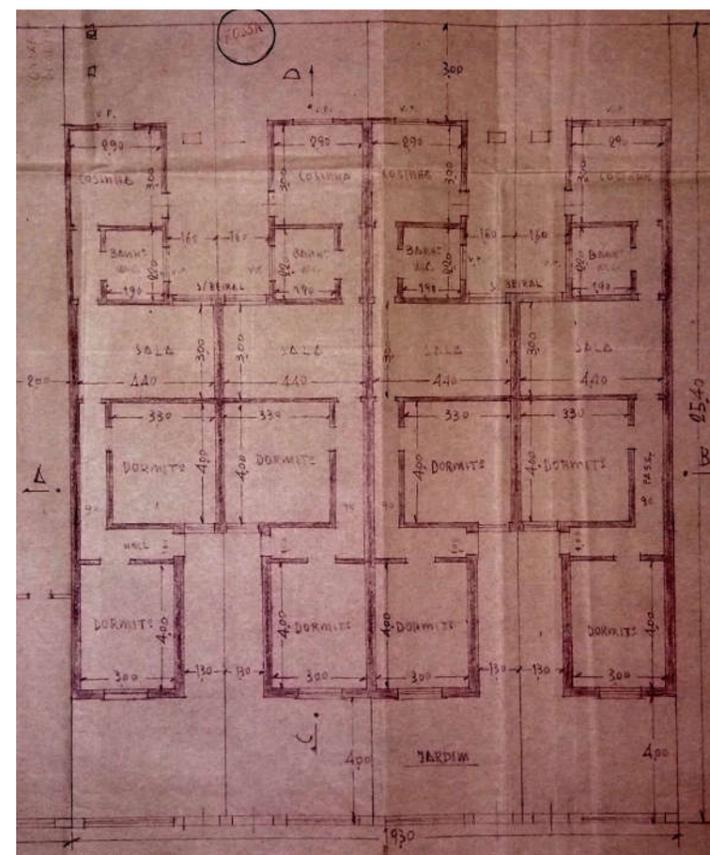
Foto do projeto, com o detalhe da planta. Fonte: (GUARULHOS, 1949).
